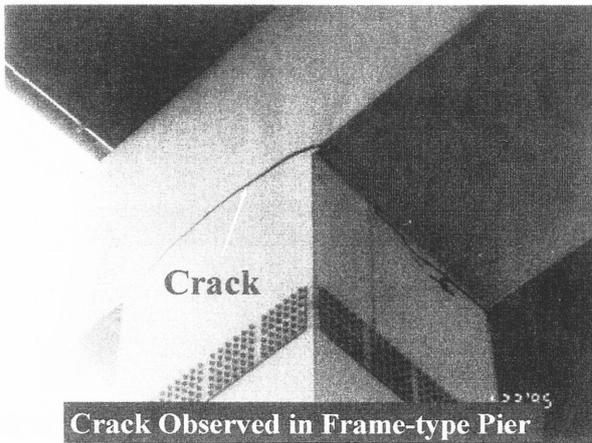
ラーメン橋脚隅角部の溶接割れ
